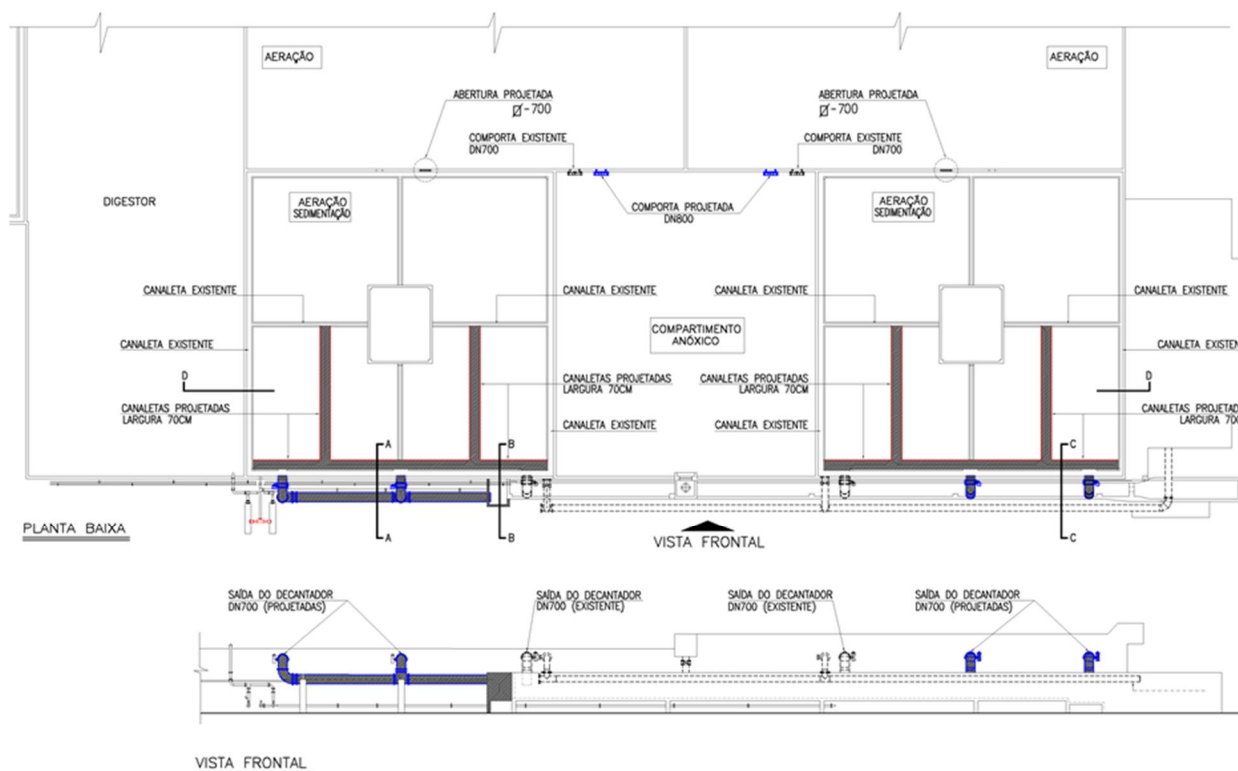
ĩ Proposição de melhorias hidráulicas na ETE Araças - Planta
